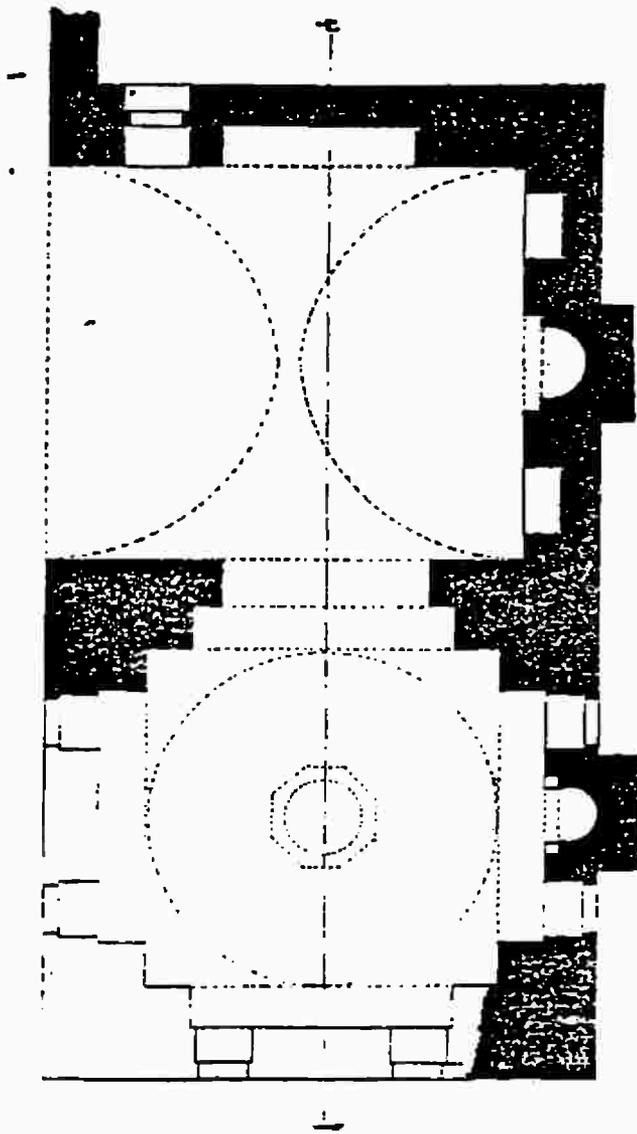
مسقط أفقي لفساقى مدفن طراباي الشريفى بباب الوزير
